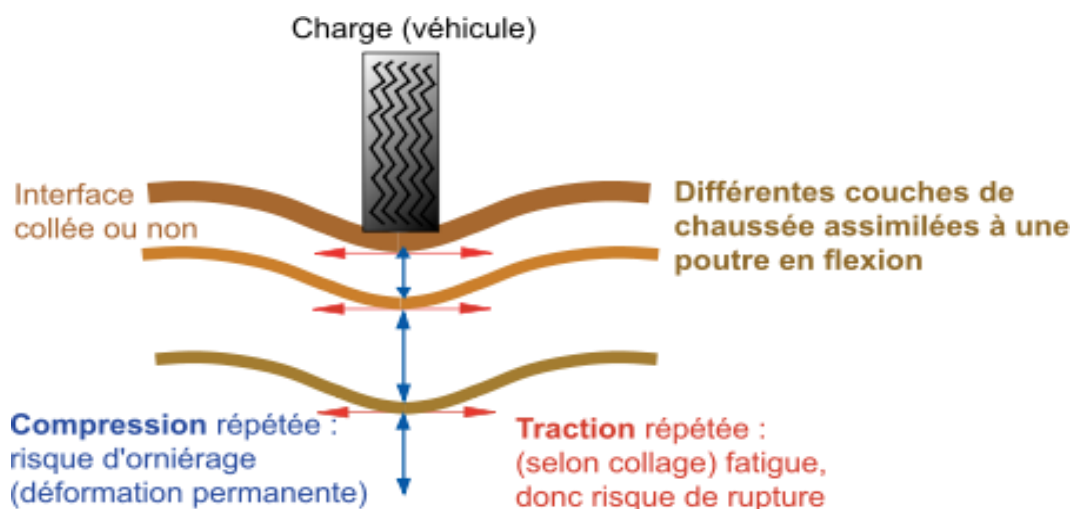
Fonctionnement d'une structure de chaussée sous l'application d'une charge roulante
